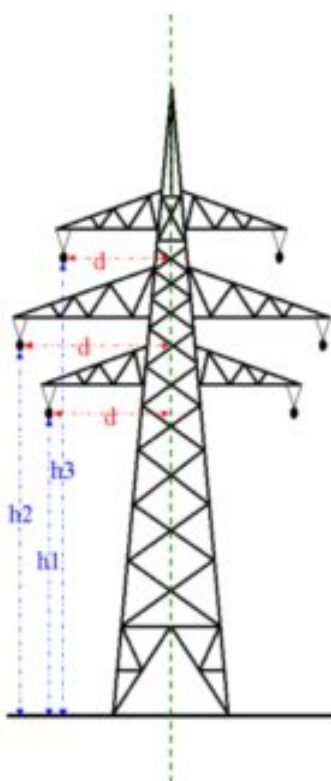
Traliccio tipo considerato nella progettazione delle linee elettriche dalla stazione di smistamento alle due linee elettriche esistenti.
